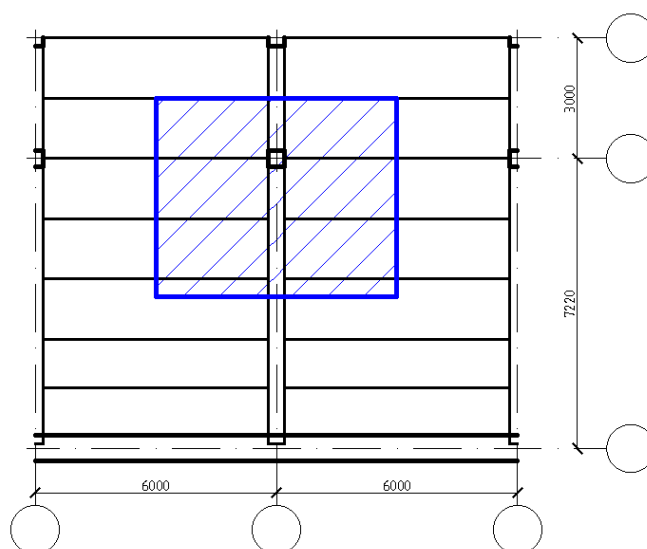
Грузовая площадь колонны 1КНД 42–1.32
